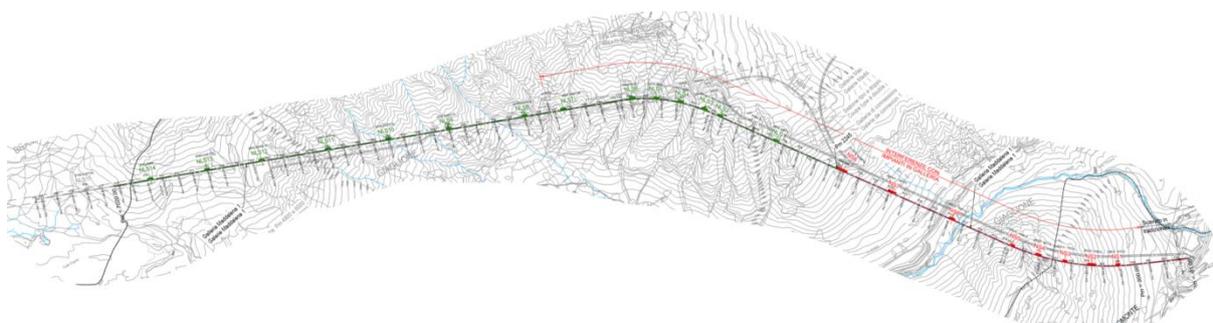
Planimetria cunicolo con indicazione delle nicchie da realizzarsi
